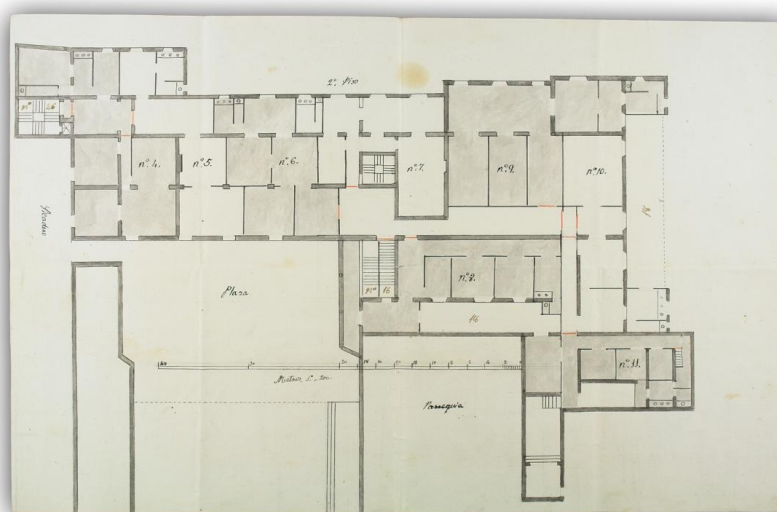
Primera planta del palacio. Propuesta de división en apartamentos.
